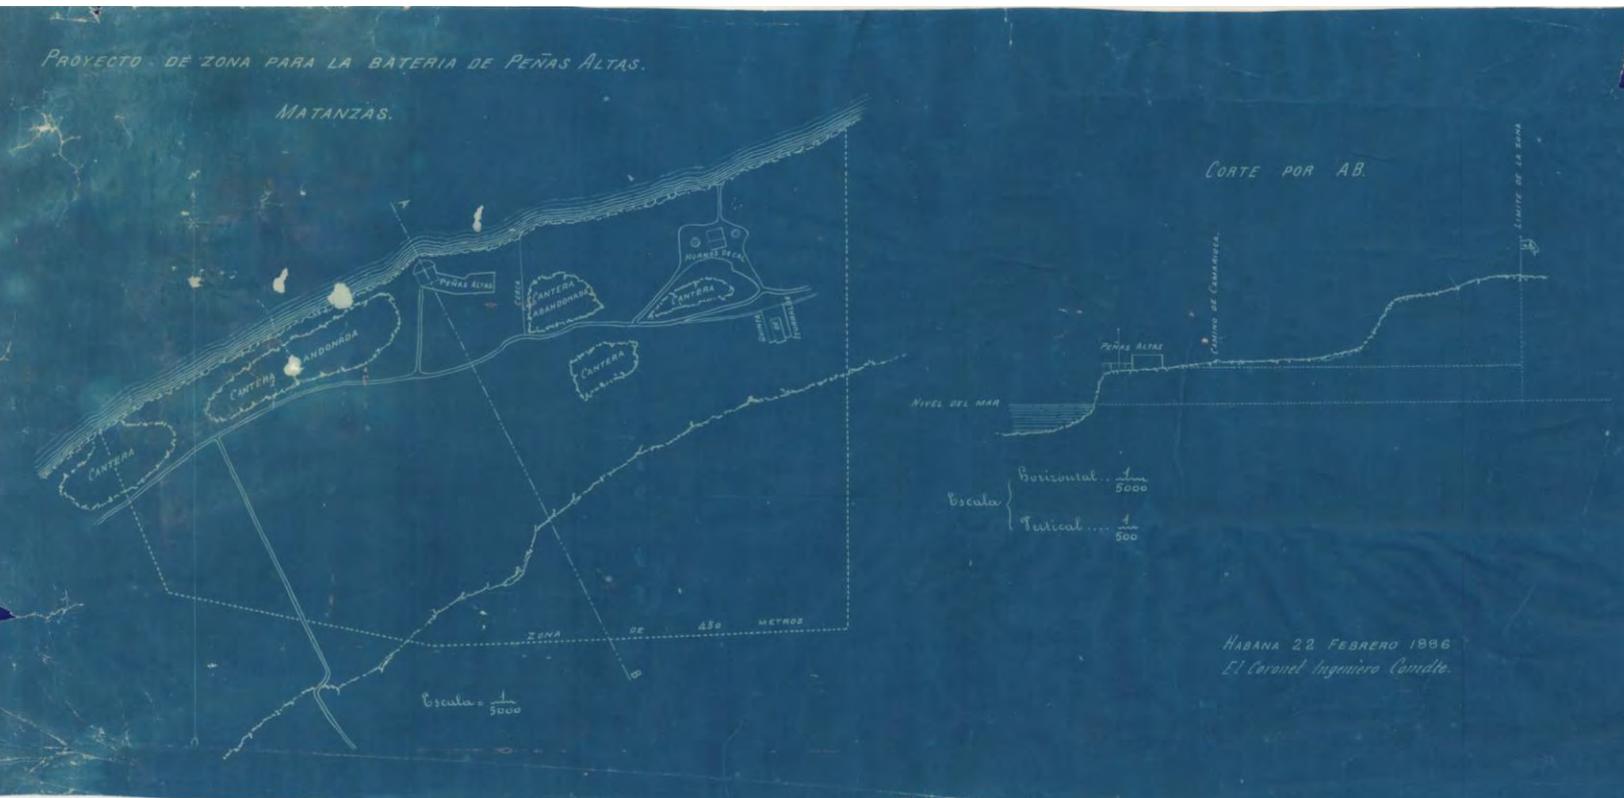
Proyecto de zona para la batería de Peñas Altas elaborado por Enrique Amado Salazar (1886). Incluye la planta y perfil de la fortificación, así como las canteras cercanas.
